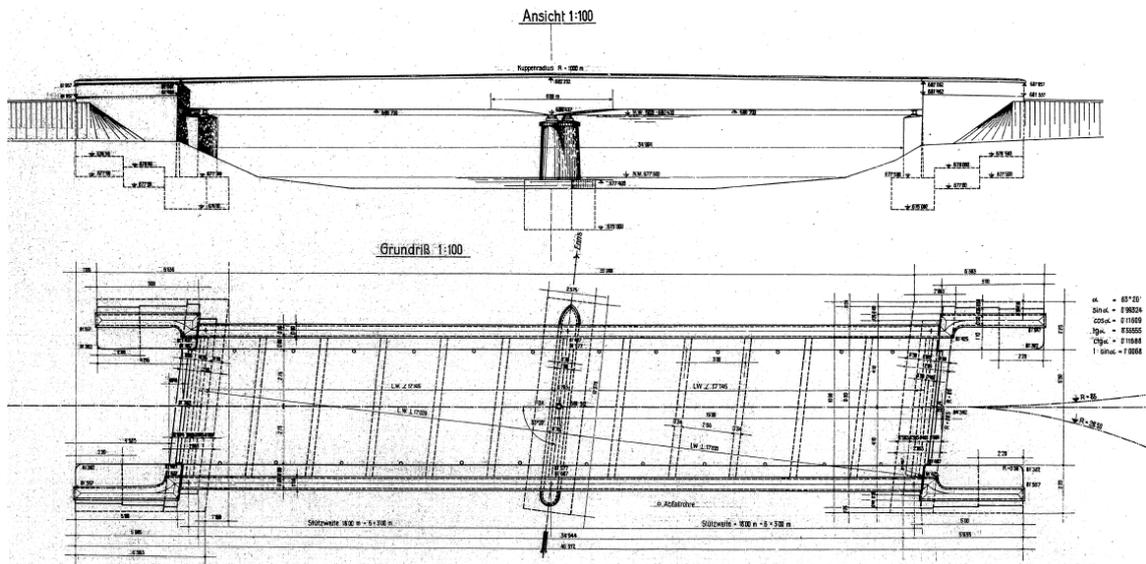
Bestand, Grundriss und Ansicht
